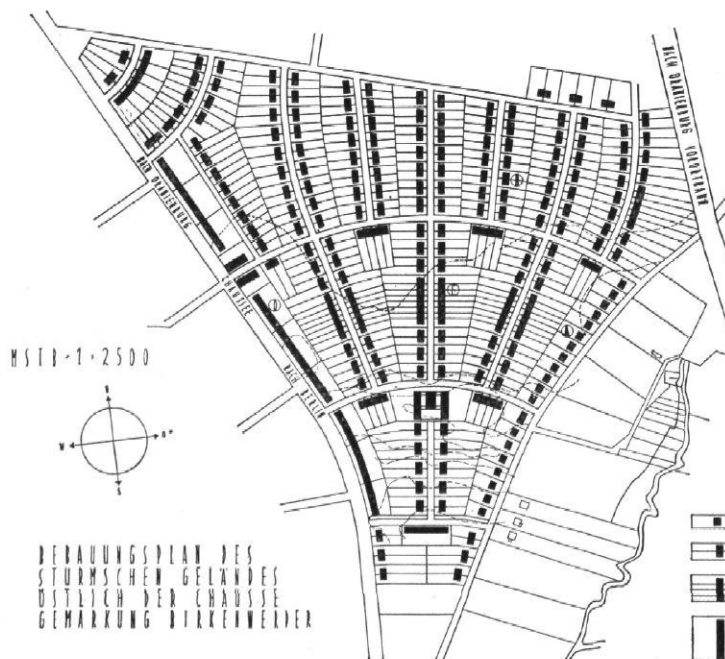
/ Siedlung Birkenwerder Lageplan / Maßstab 1:20000
